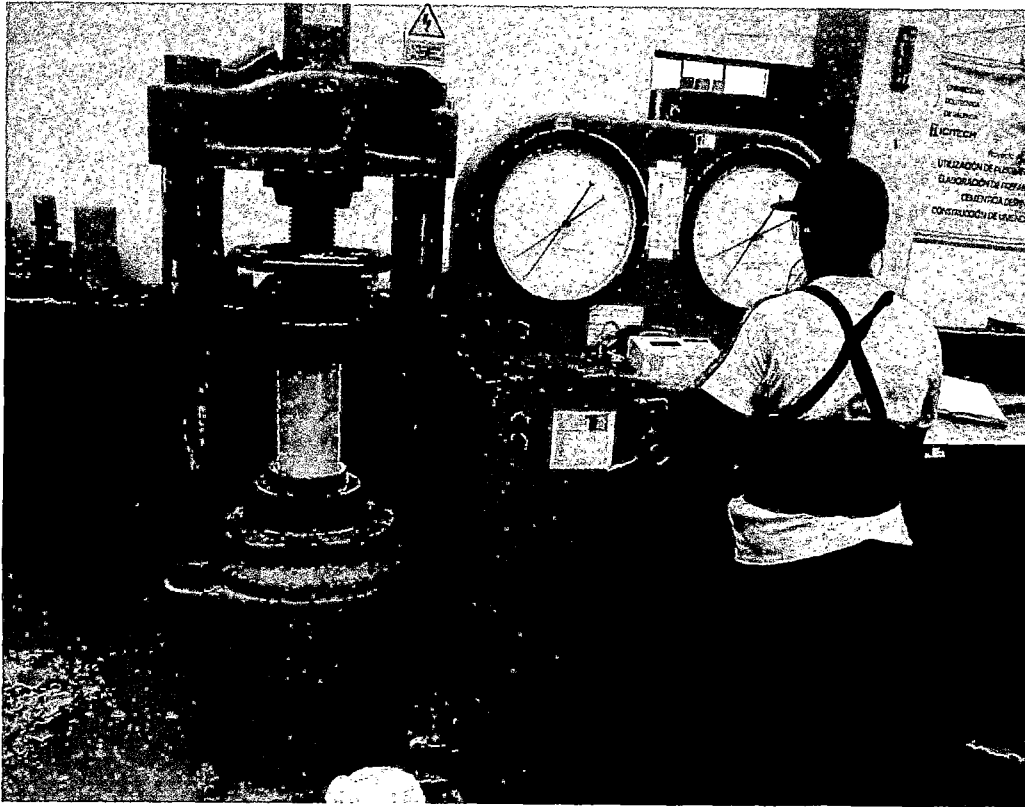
Máquina Compresora rompiendo Probetas.
